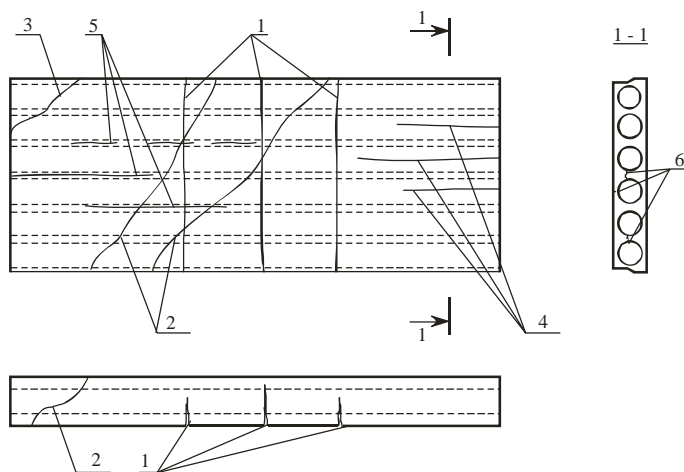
Силовые и технологические трещины в многопустотной панели перекрытия:
